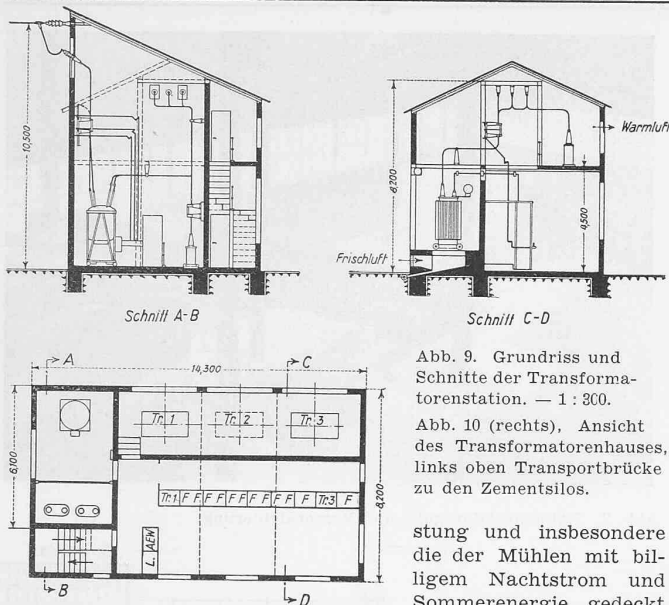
Grundriss und Schnitte der Transformatorstation. — 1 : 300.
